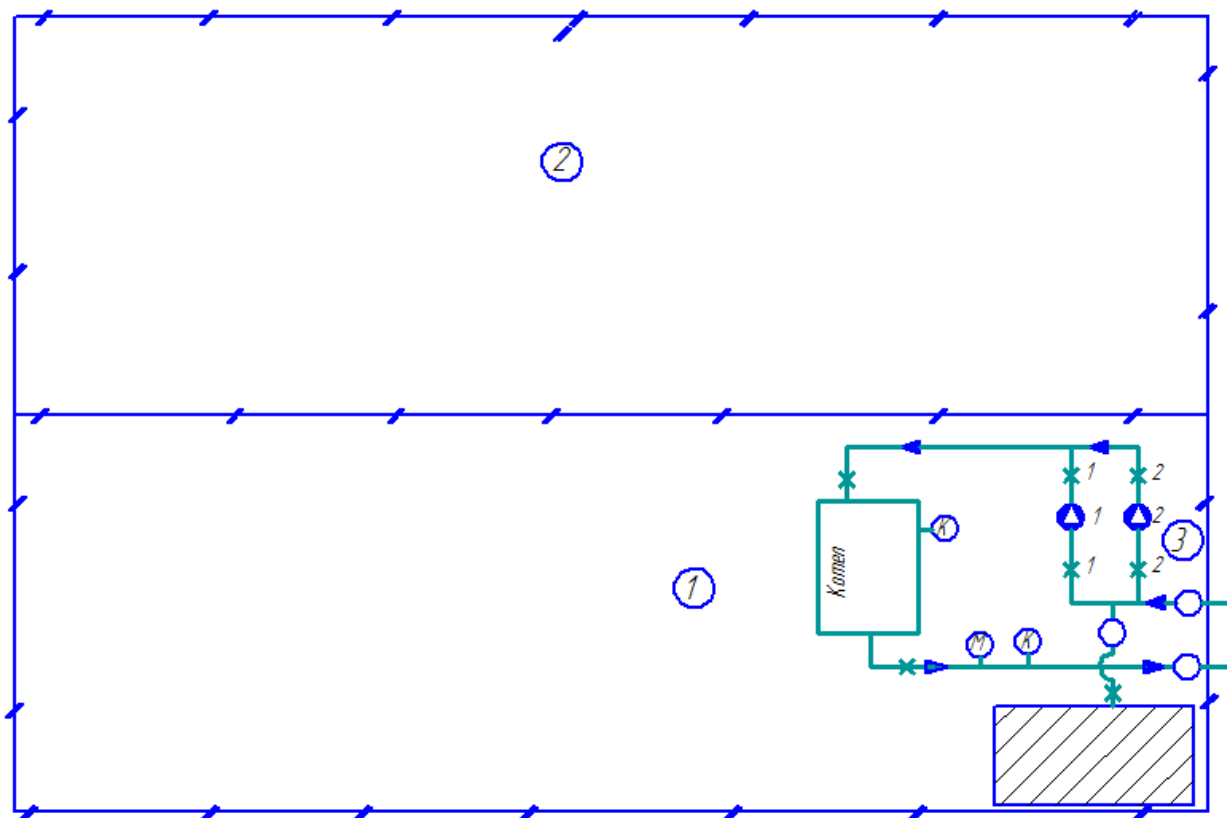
Тепловая схема котельной № 5: 1 – котельное помещение; 2 – склад топлива; 3 – насосная
